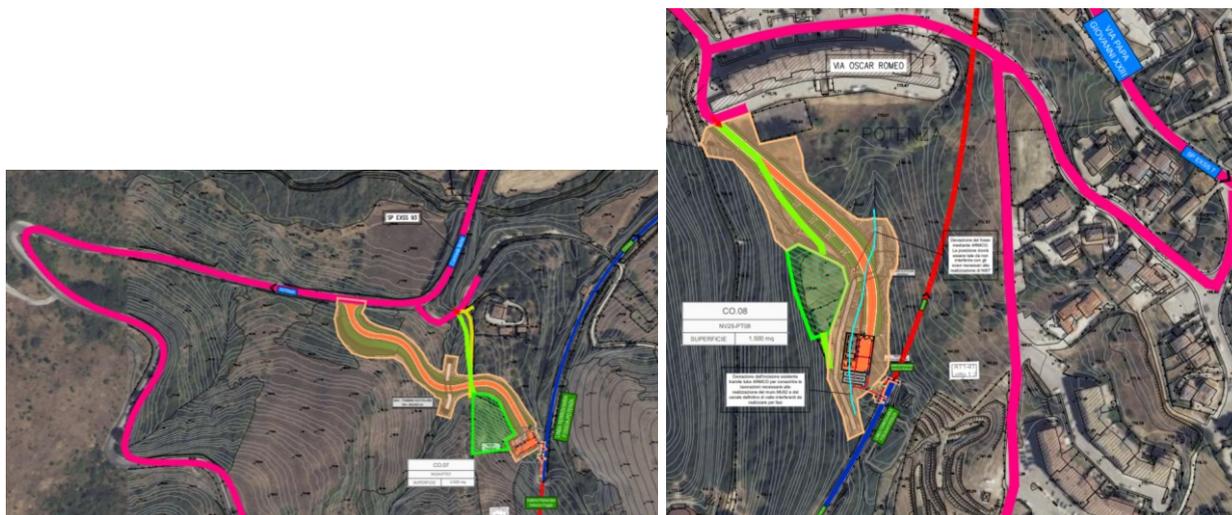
Planimetria con indicazione delle aree di cantiere e della viabilità connessa. Galleria Pietracolpa lato Foggia (sinistra) e lato Potenza (destra) (Fonte: Allegati alla Lista di controllo)
